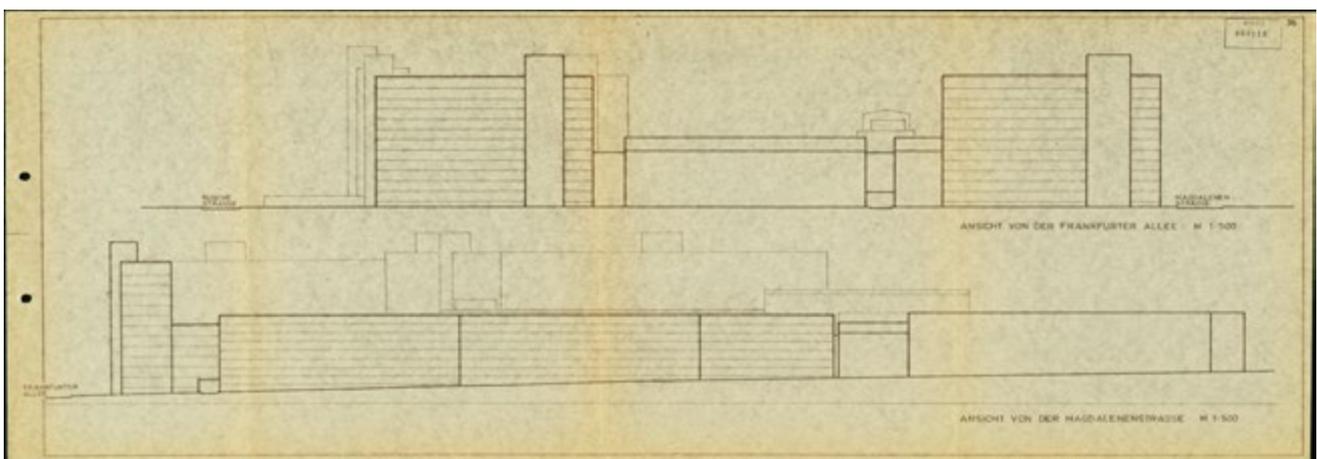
Entwurfszeichnung Neubauten Frankfurter Allee und Magdalenenstraße - undatiertes Entwurf (SHB) [BStU]
